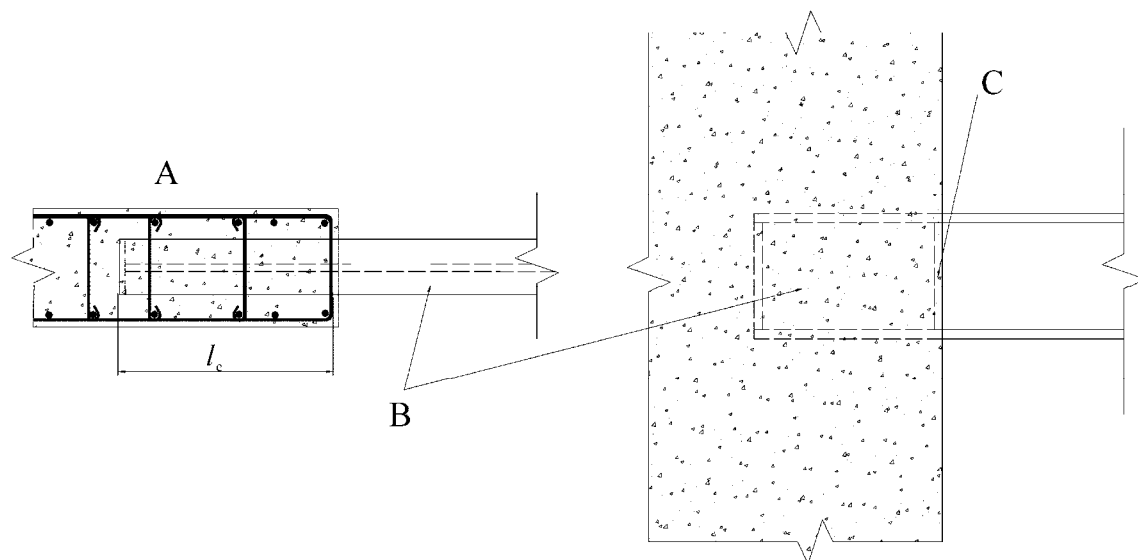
Disposições construtivas de elementos de bordo mistos parcialmente revestidos (pormenorização das armaduras transversais para a classe de ductilidade DCH)
